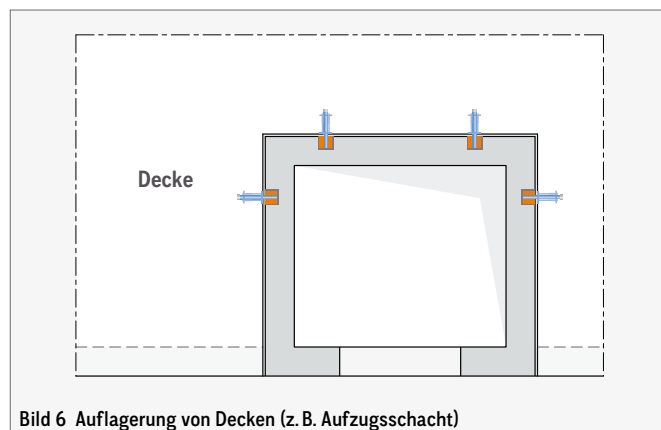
Auflagerung von Decken (z. B. Aufzugsschacht)
